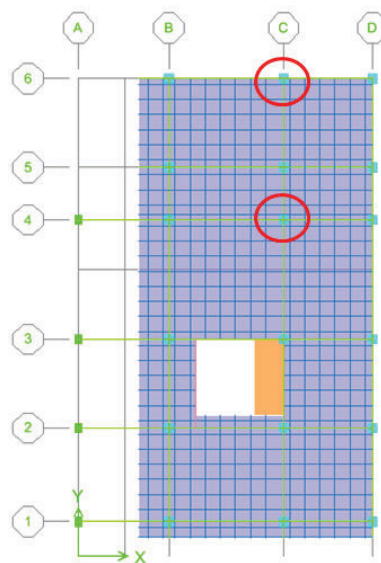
CONEXIONES LOSA – COLUMNA A SER CHEQUEADAS EN ELEVACIÓN.
